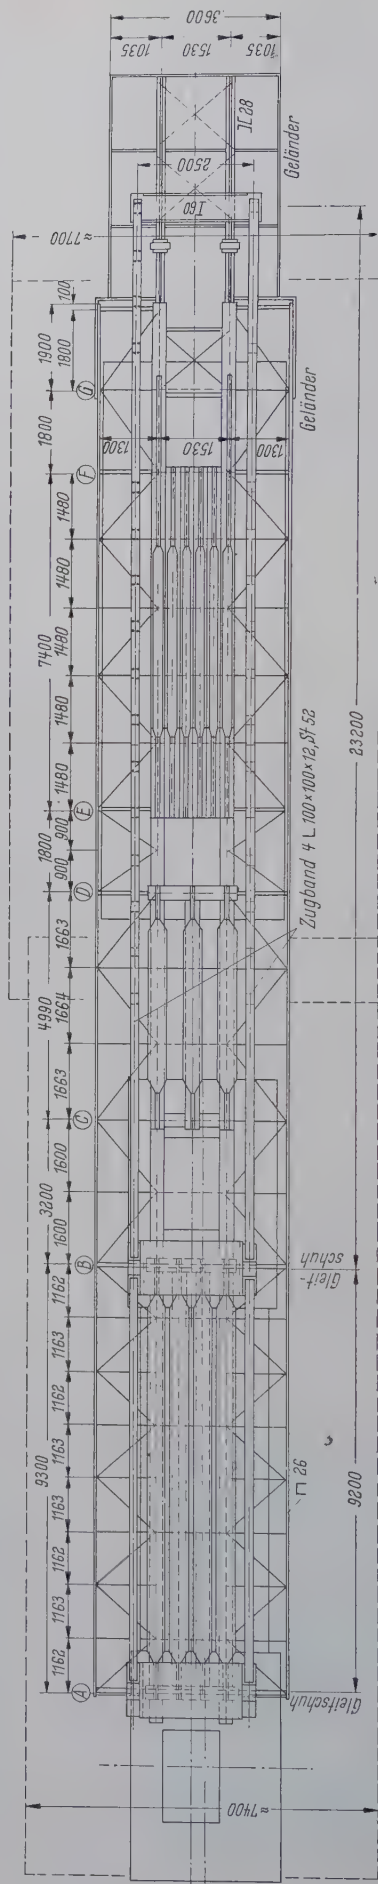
Längsansicht und Draufsicht der Verschiebubahn
